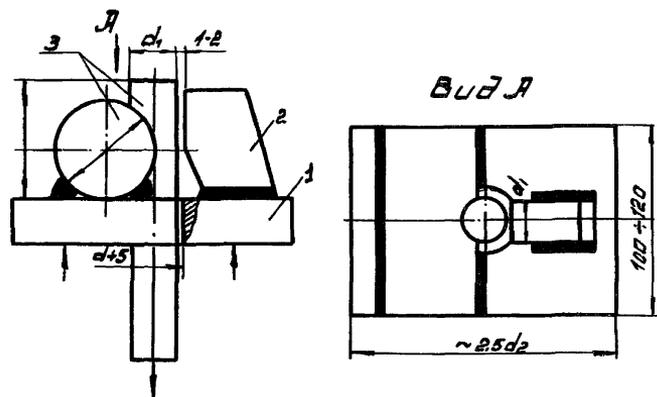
Схема испытаний на срез крестообразного соединения стержней крупных диаметров.
